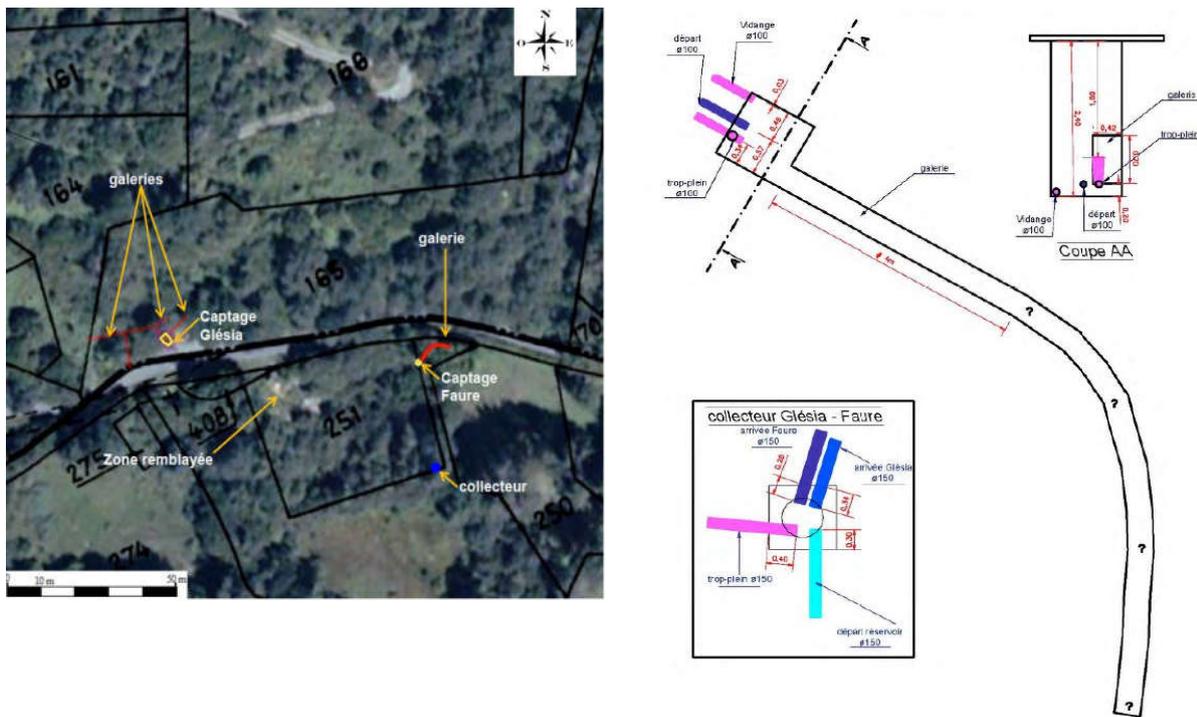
PLAN DE SITUATION DU CAPTAGE FAURE ET SCHEMA DE L'OUVRAGE (document CETRA)
